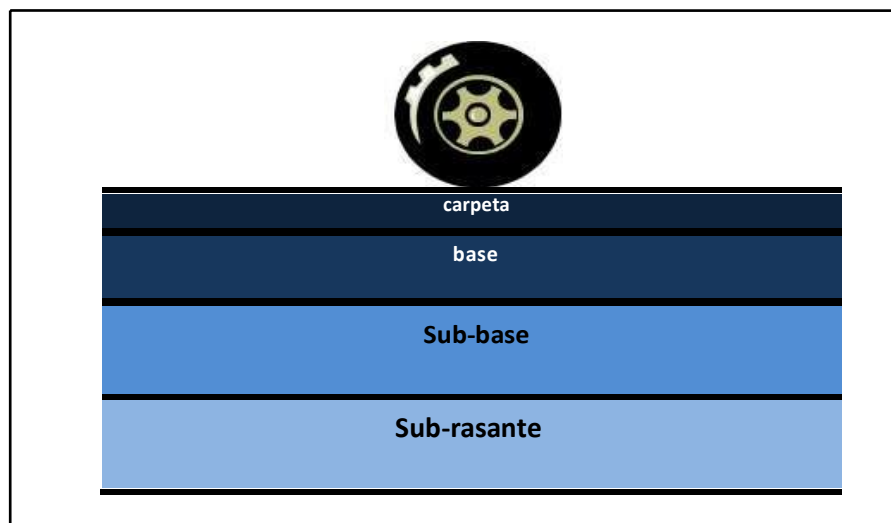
Esquema típico del paquete estructural de un pavimento flexible
